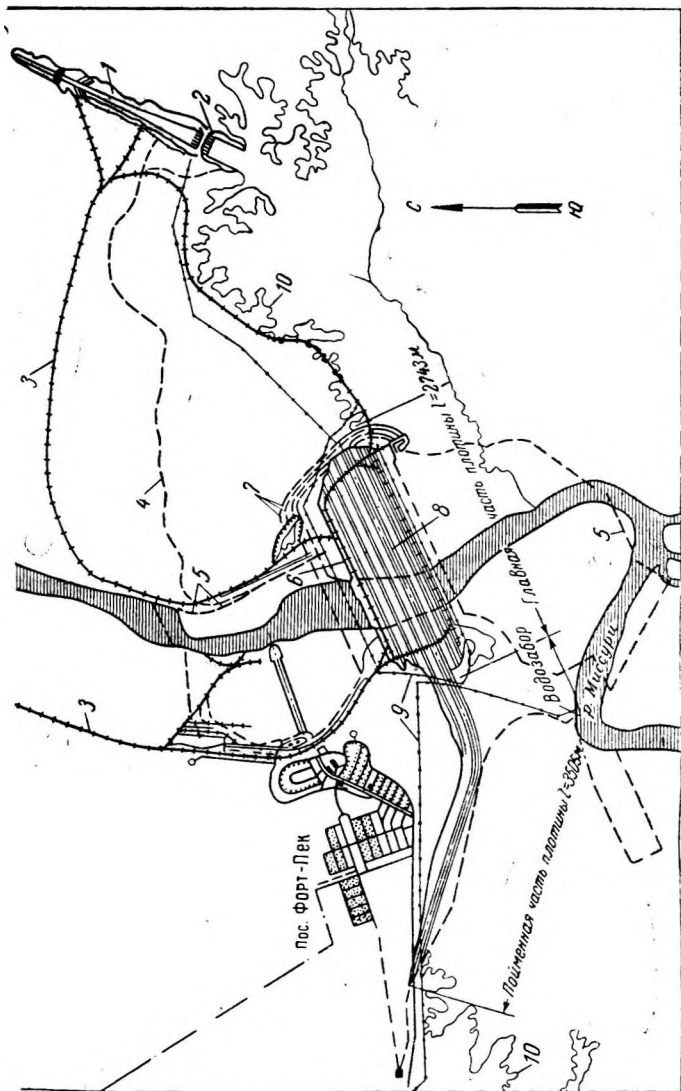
План узла сооружений, создающих водохранилище Форт Пек.
